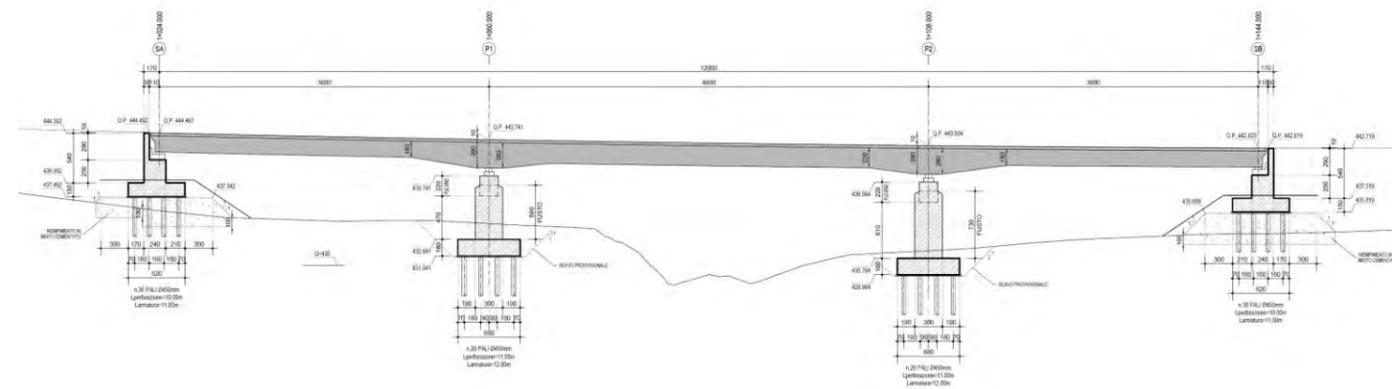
Sezione longitudinale lungo asse tracciamento
